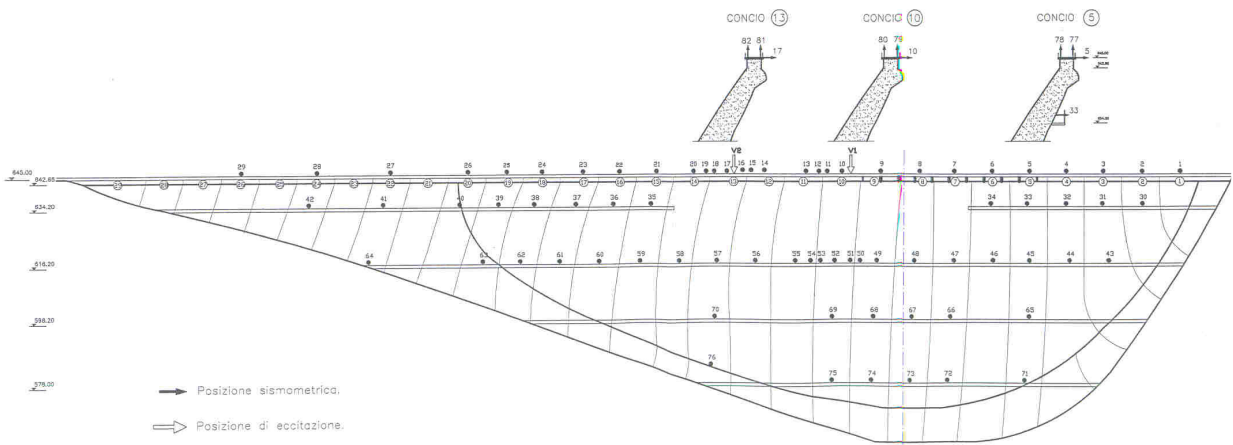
Vista planimetrica e della sezione maestra della diga di Gusana
